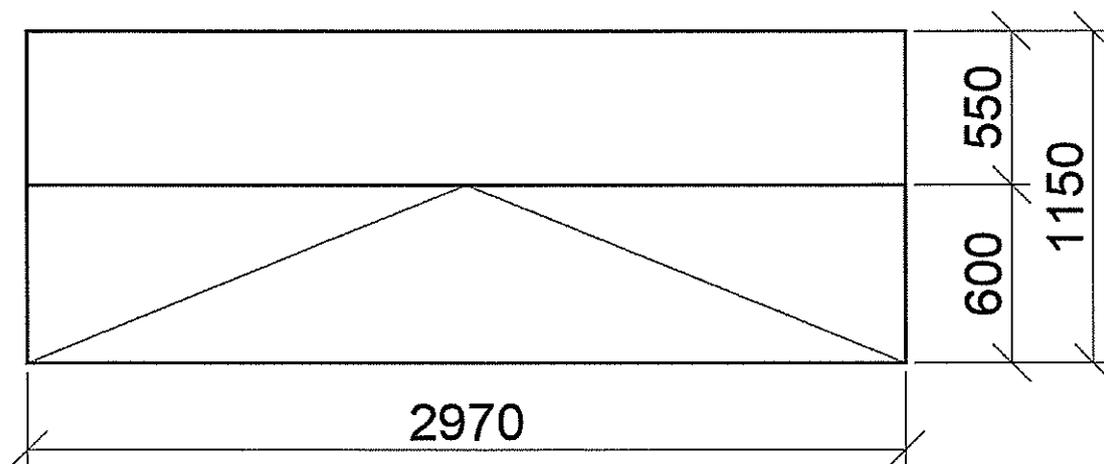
Эскиз оконного блока с конструктивными размерами в мм
